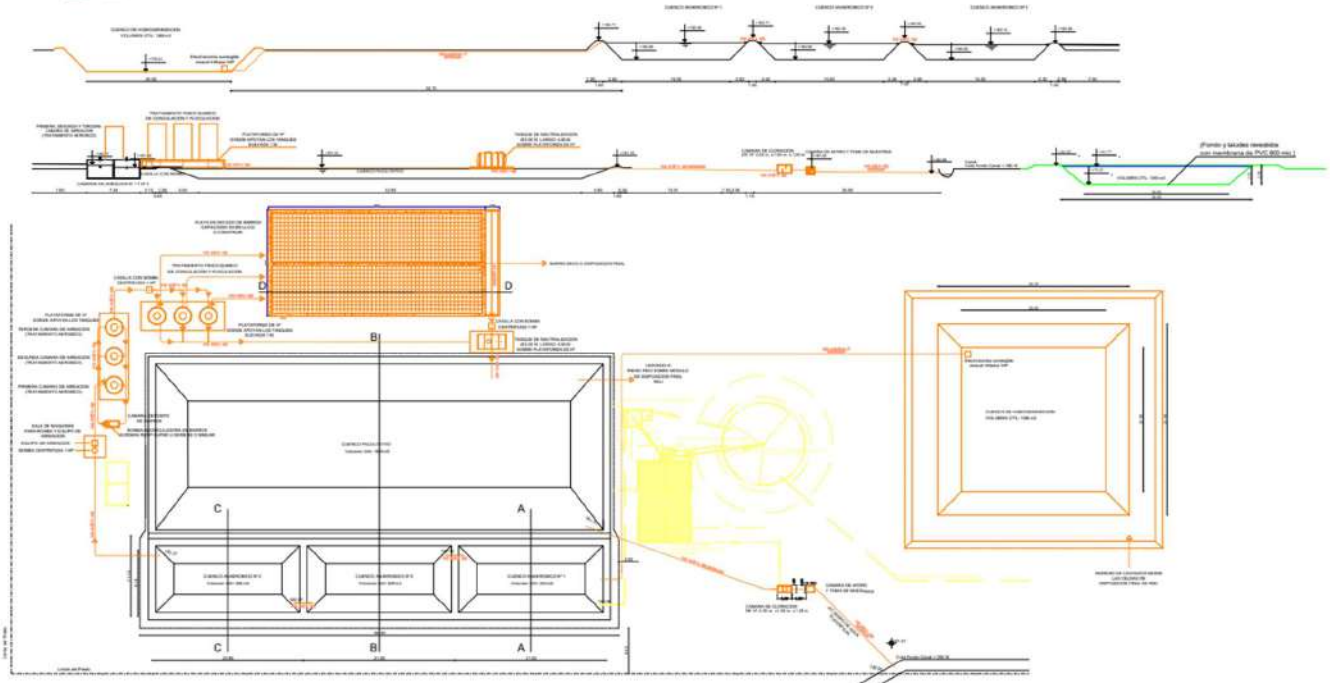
Proyecto de Planta de Tratamiento de Lixiviados.
